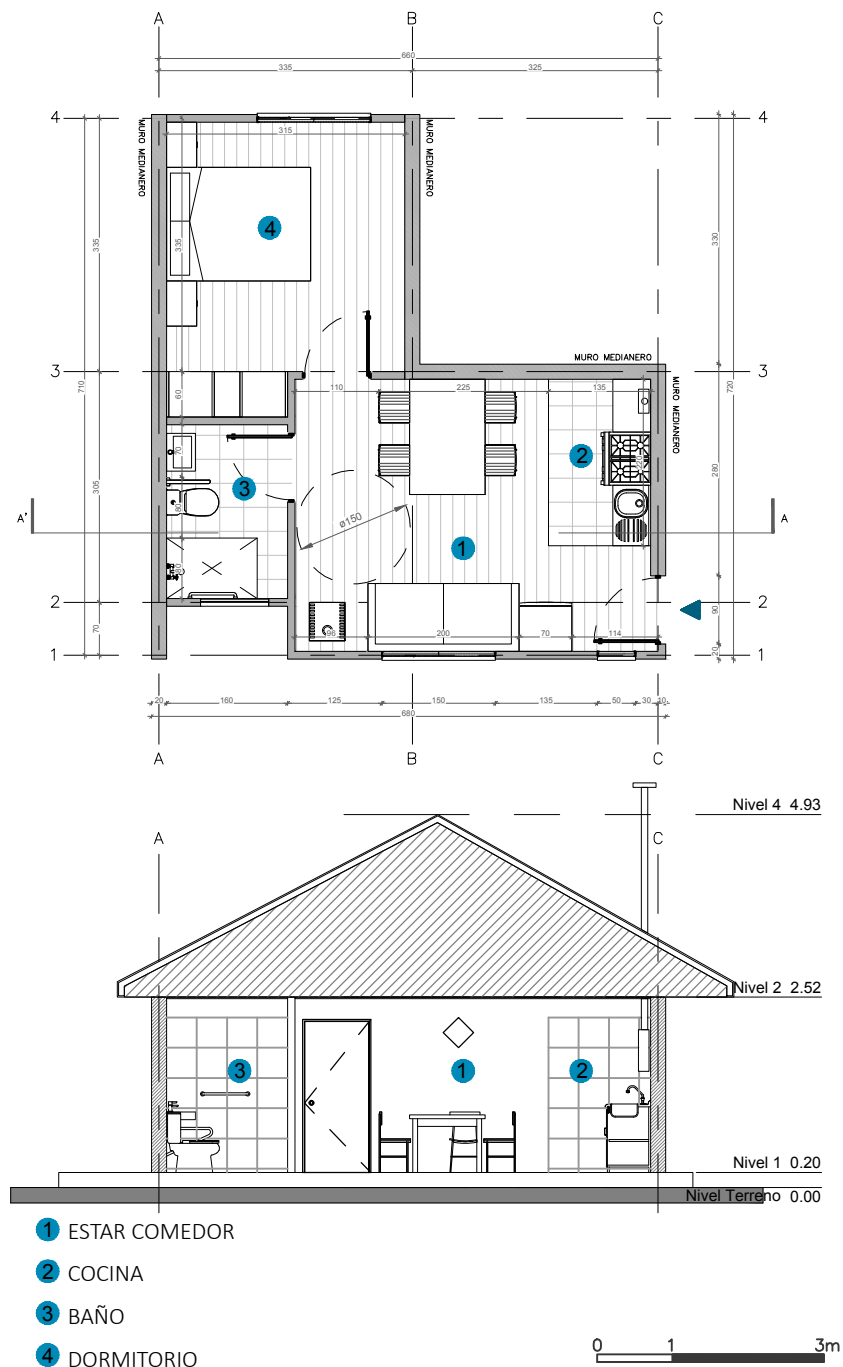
Planta y corte de una vivienda tipo CVT Coyhaique.
